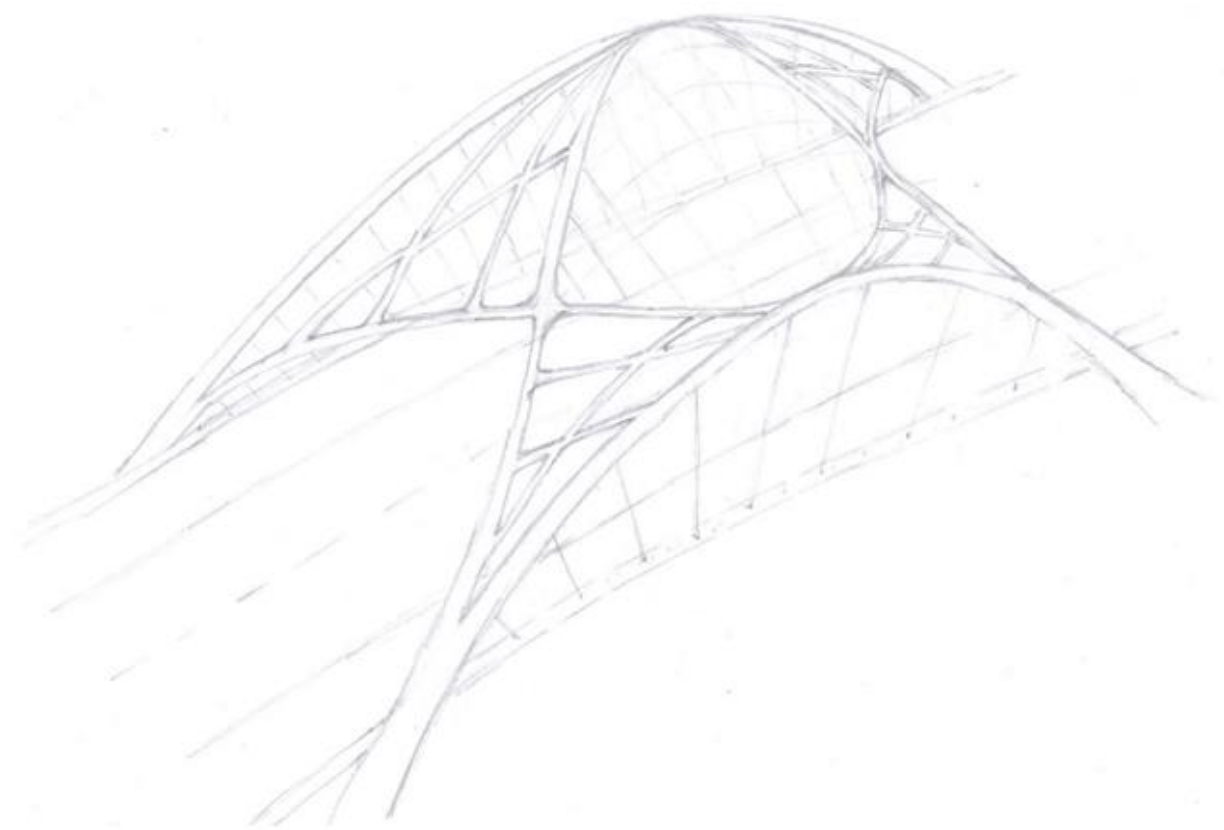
PLANTA DISPOSICIÓN PUENTE ALTERNATIVA 1
